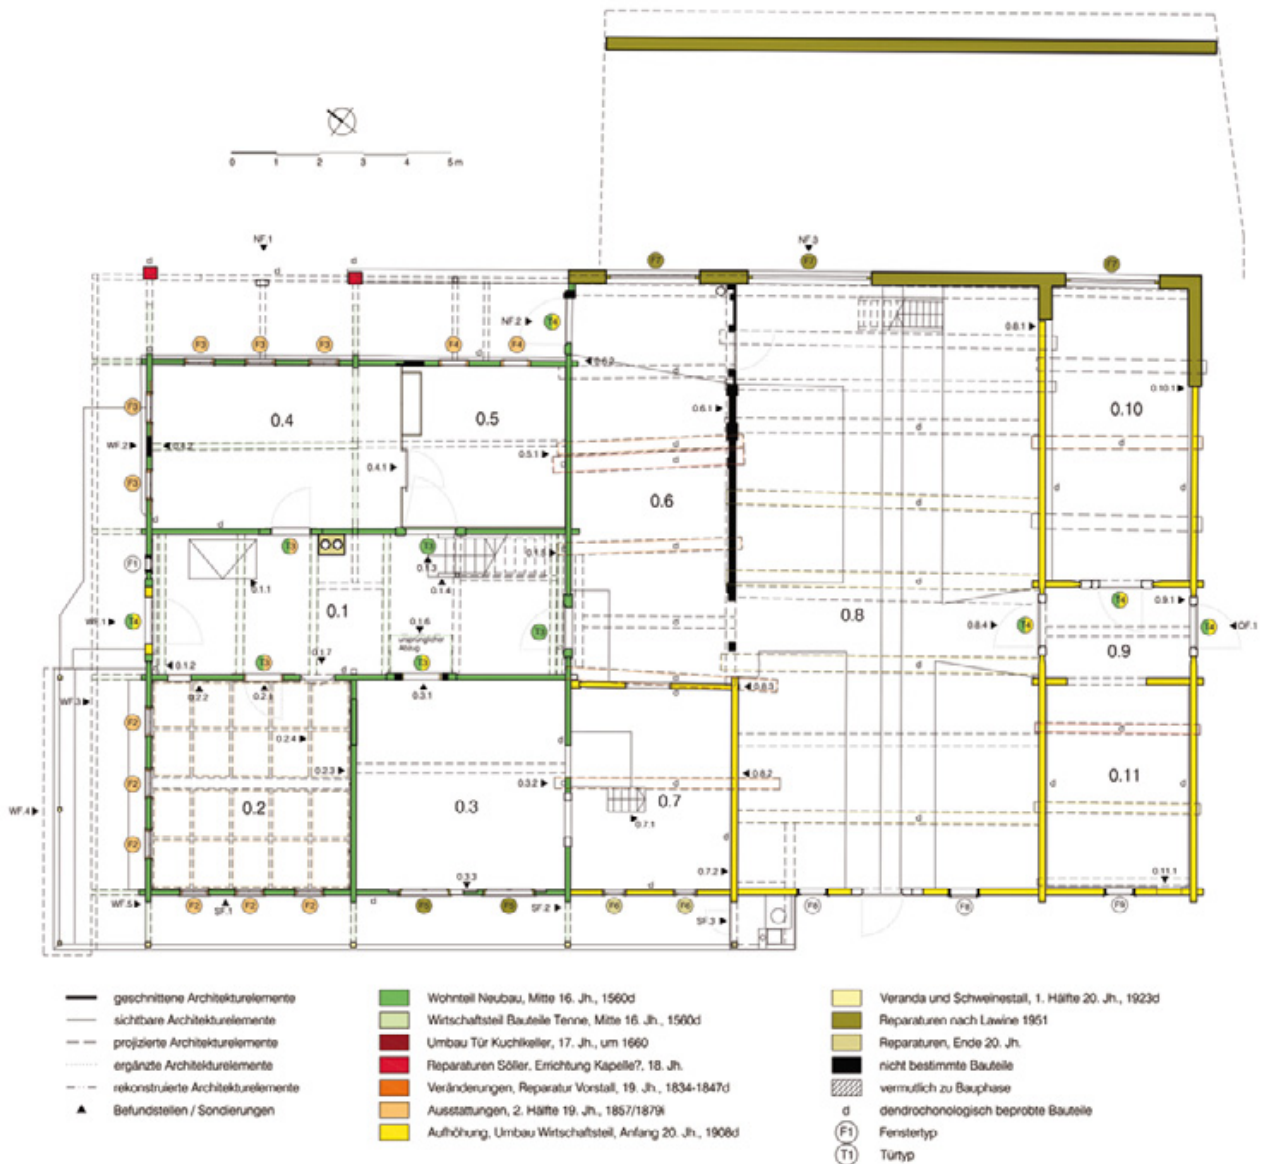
Alpbach, Hof Lueg. Baualterplan des Erdgeschosses.
